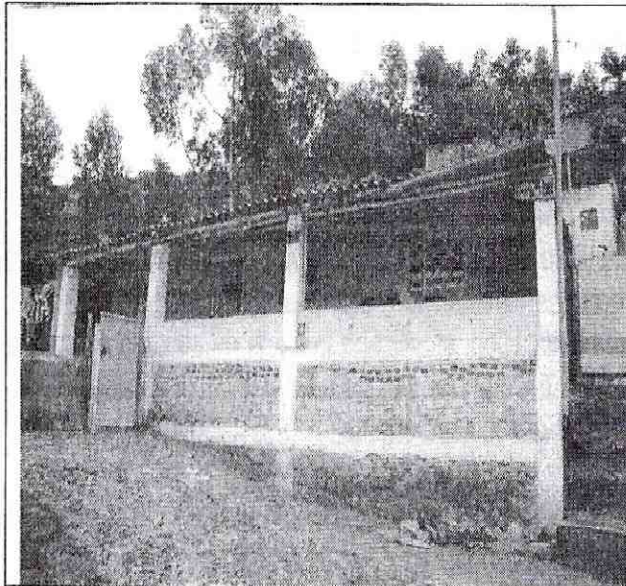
Vivienda del predio de la Calle 163A No. 4-92 Este, localizada en la parte baja del talud de corte en cuya parte alta se localiza el Predio A.
